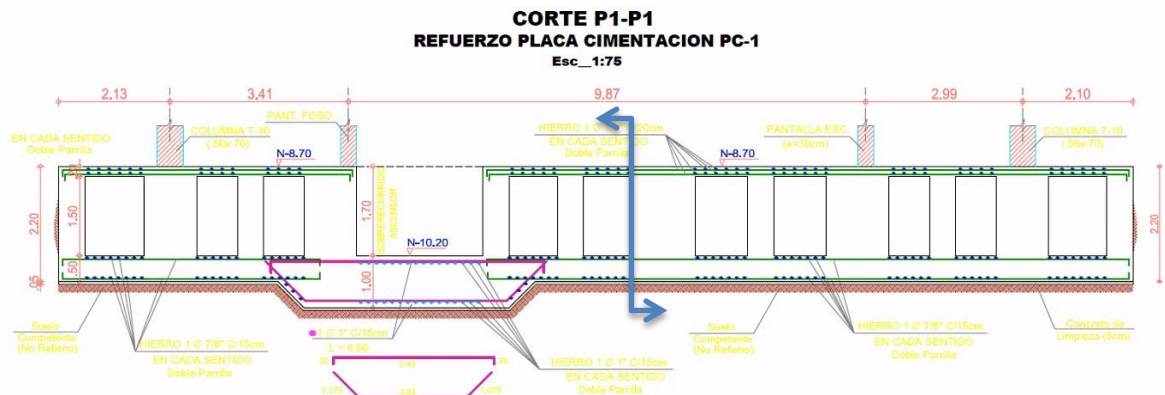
Corte transversal P1-P1, acero de parrillas superior e inferior para losa de cimentación PC-1.
